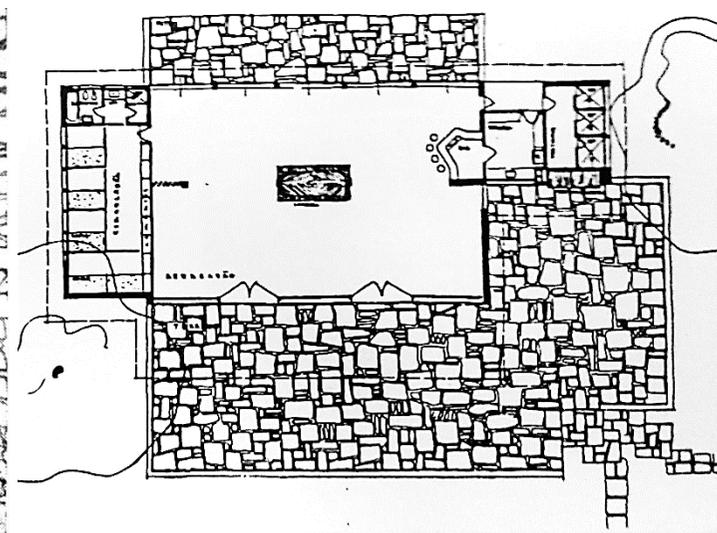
Planta baixa do Pavilhão Aricanduva.
